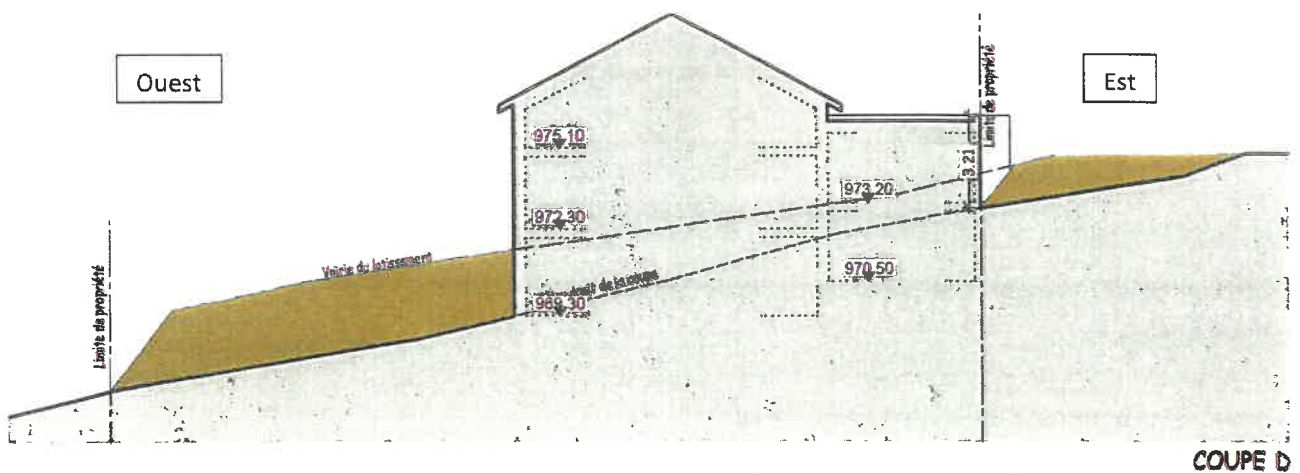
Vue en coupe du projet sur le lot n°3 (SARL Paillard Archi & Co)
